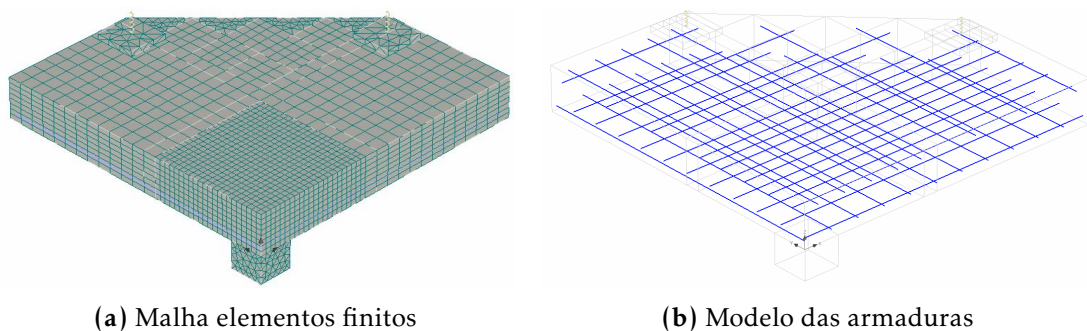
Modelo numérico de laje: (a) discretização da malha de elementos finitos e (b) armaduras longitudinais.
